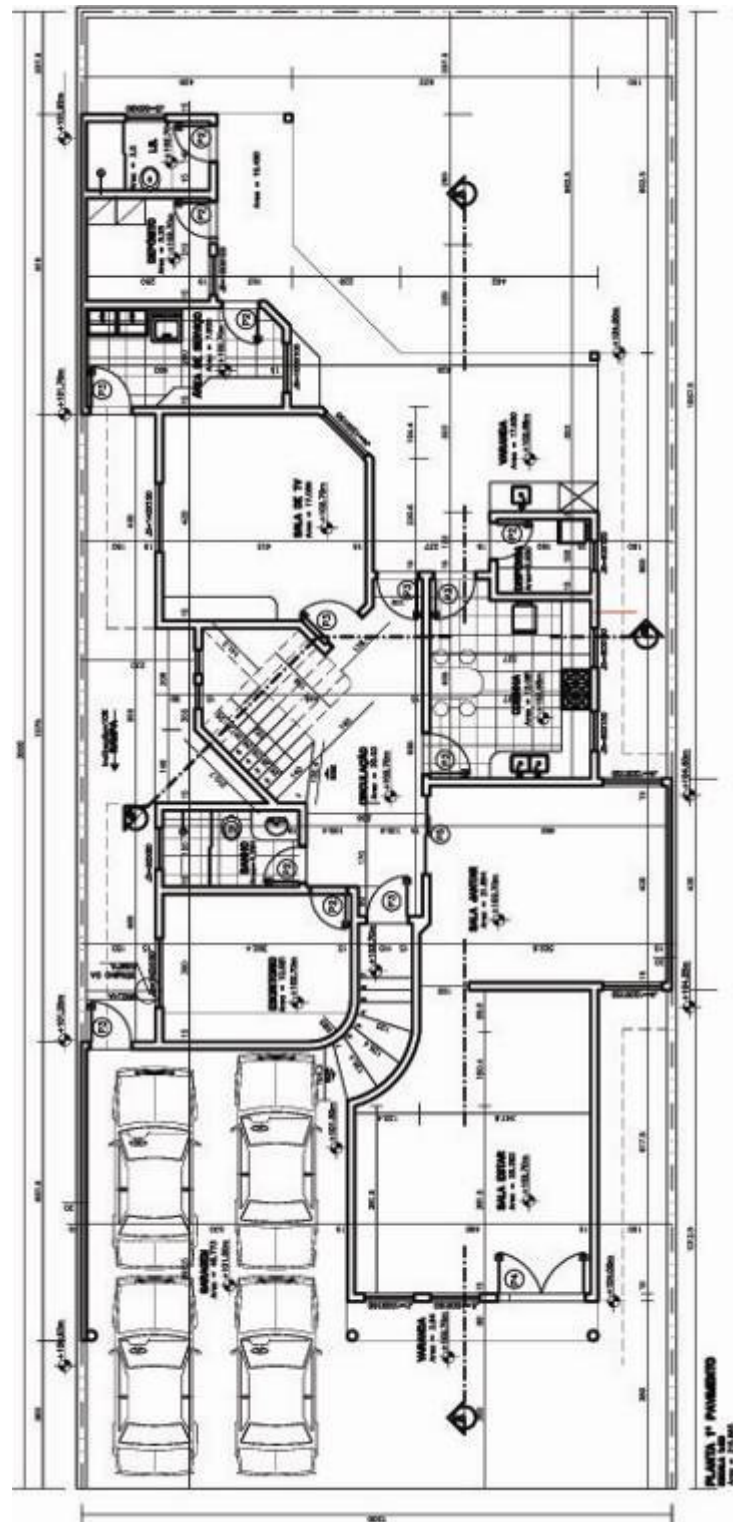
Exemplo de planta de projeto arquitetônico
